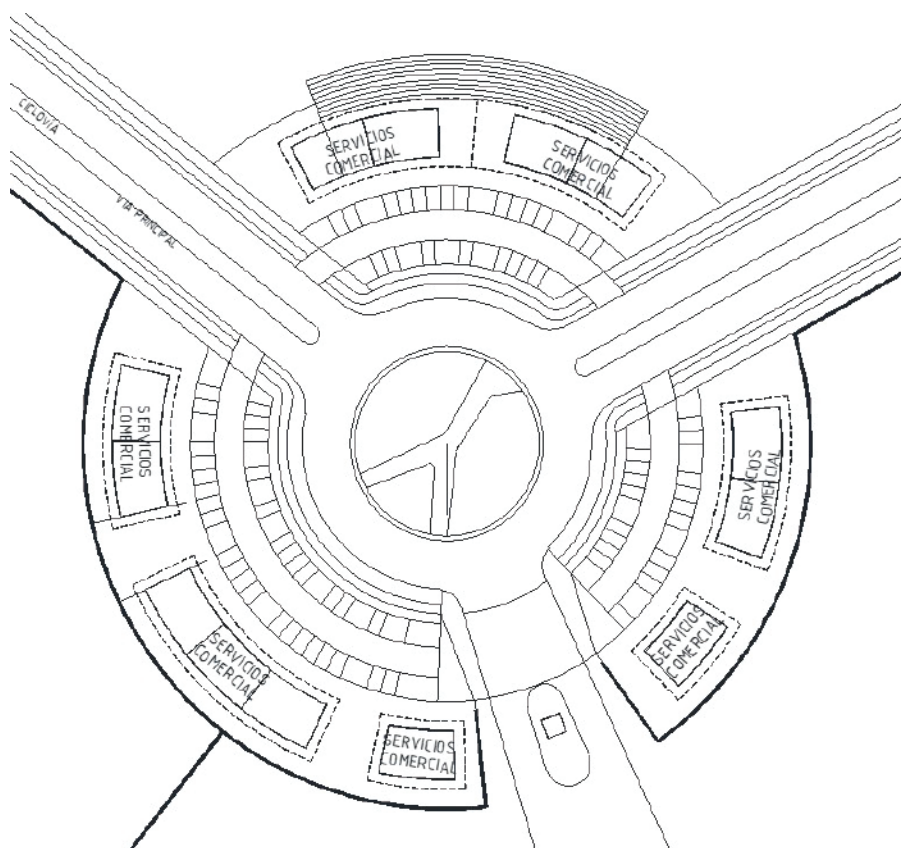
Propuesta en planta de las áreas comerciales. Fuente: Máster Plan Centauro.
